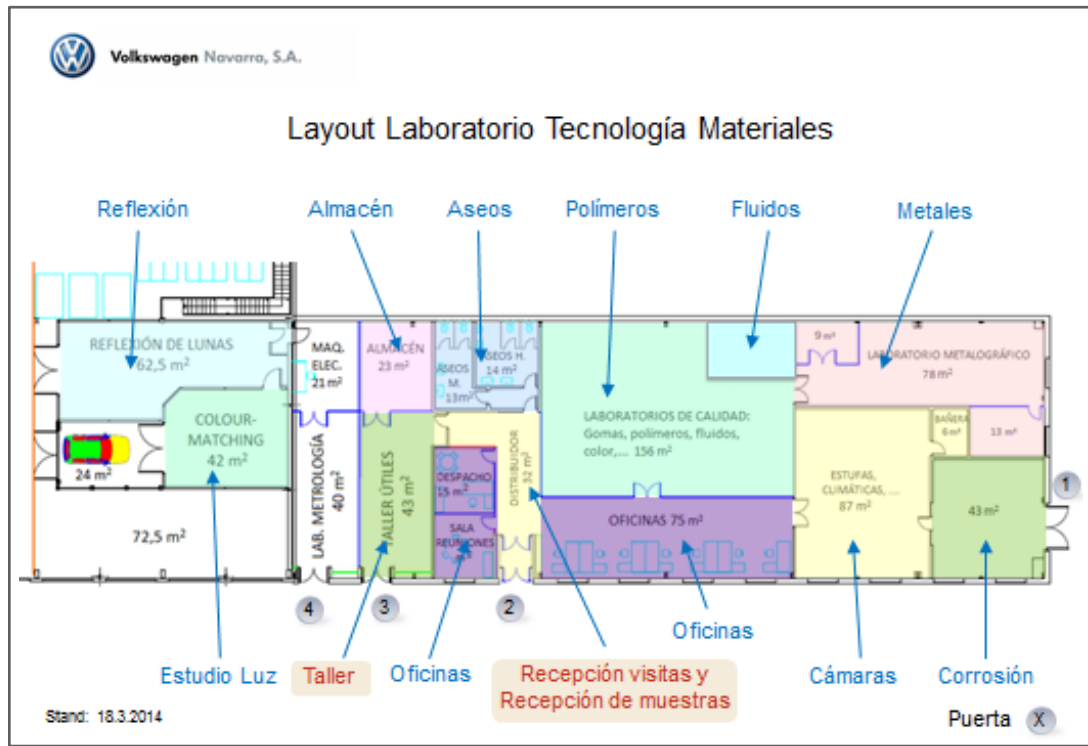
Layout Tecnología de Materiales antes reestructuración. Imagen disponible en ^[15]
